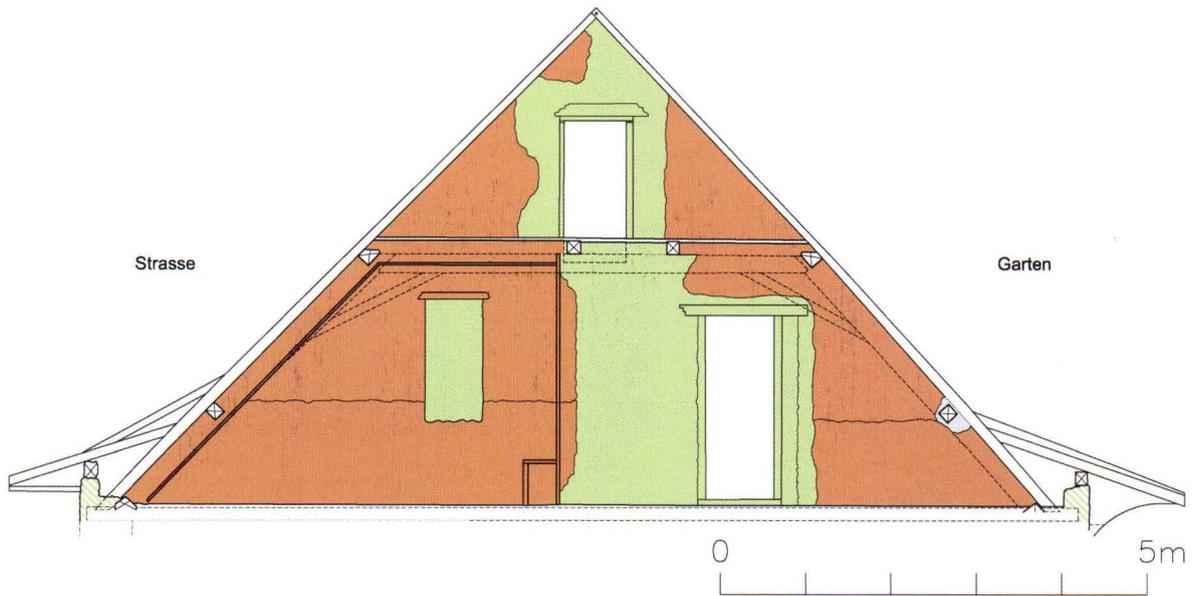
Hebelstrasse 7. Teil A, Dachgeschoss. Schnitt durch das Dach des Hauses A und Innenansicht der östlichen Giebelmauer (1576/77). Im ersten Dachgeschoss links die wohl originale, später vermauerte Fensteröffnung, rechts und im zweiten Dachgeschoss die später eingeflickten Durchgänge in die Dachräume der Erweiterung C (grün). Die Traufe wurde um 1757/58 beidseitig angehoben (grün; siehe Erweiterung C); die Strassenseite erhielt 1838 einen neuen Dachhimmel. – Zeichnung: Jukka Altermatt und Conradin Badrutt.
